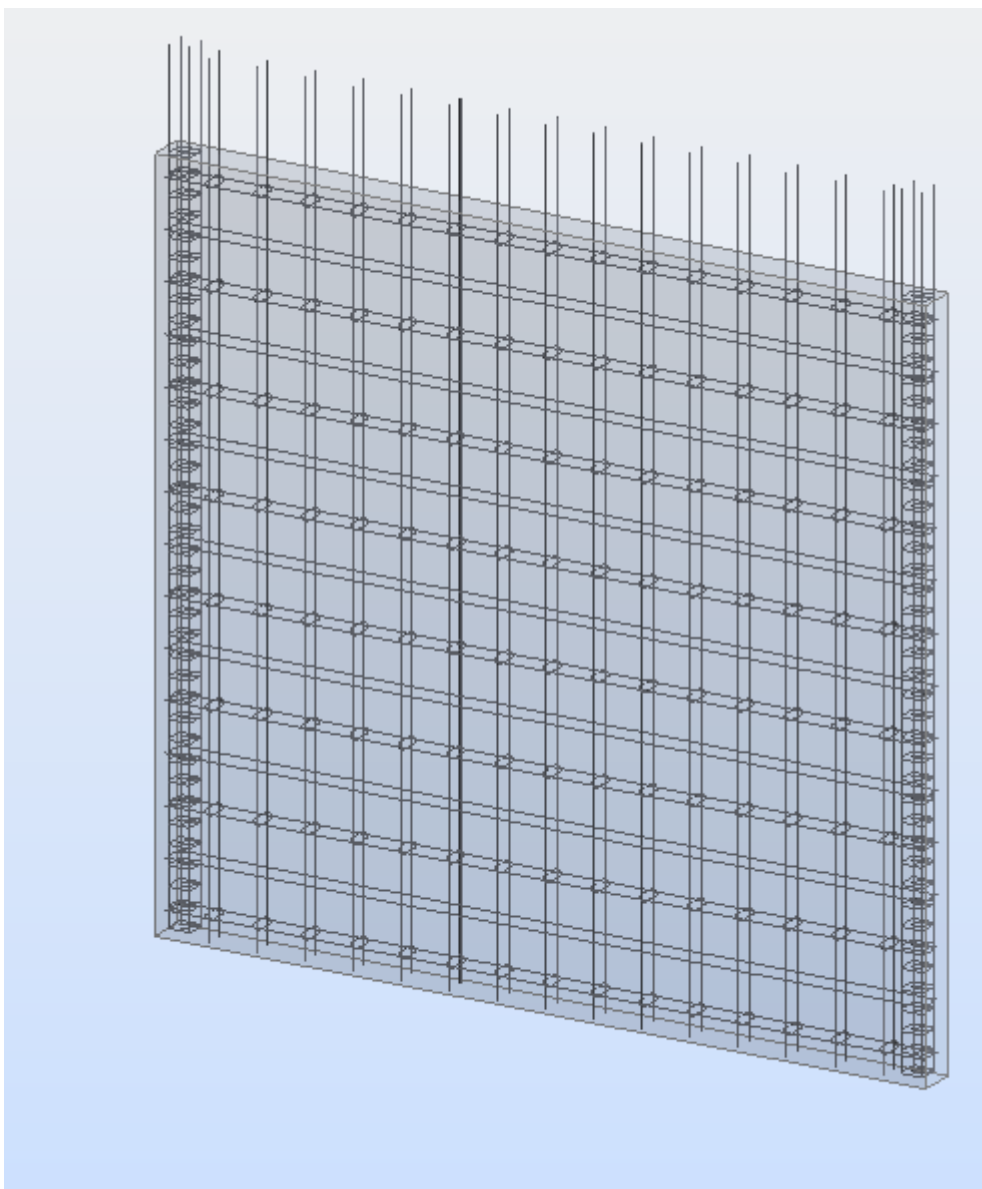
Vue 3d de Ferrailage de Voile N°02
